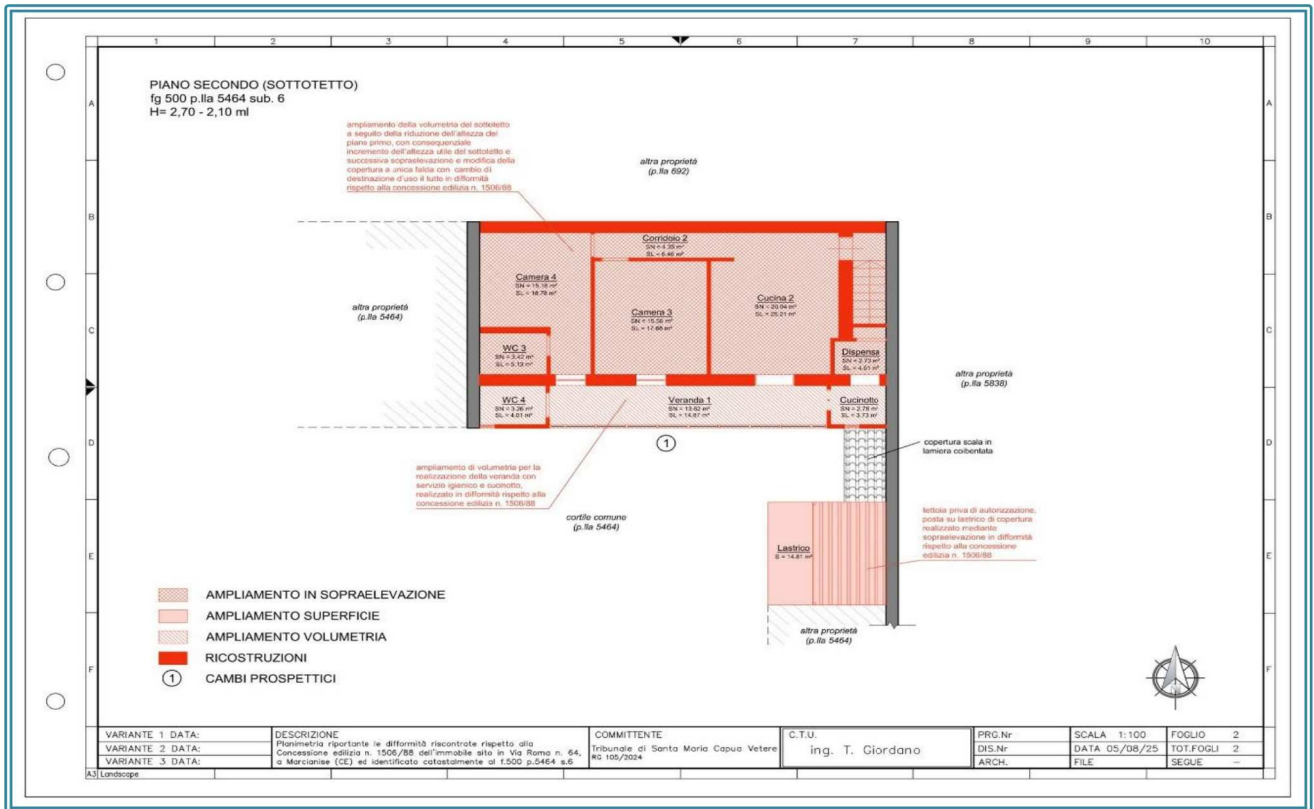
Schema difformità urbanistiche – Piano Secondo (sottotetto)
